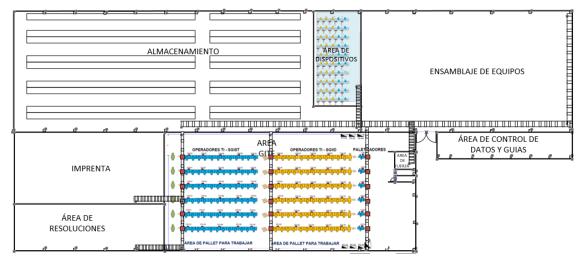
distribución de las canaletas tipo escalerilla en las áreas a instalar
